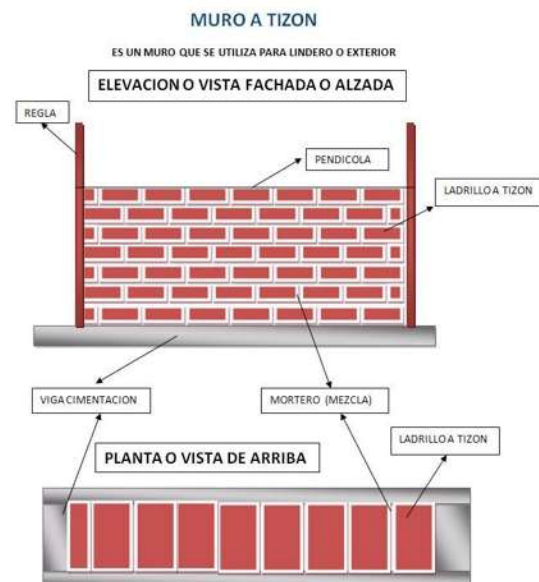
Detalle constructivo de muro. ideasconstruccion.blogspot.com
